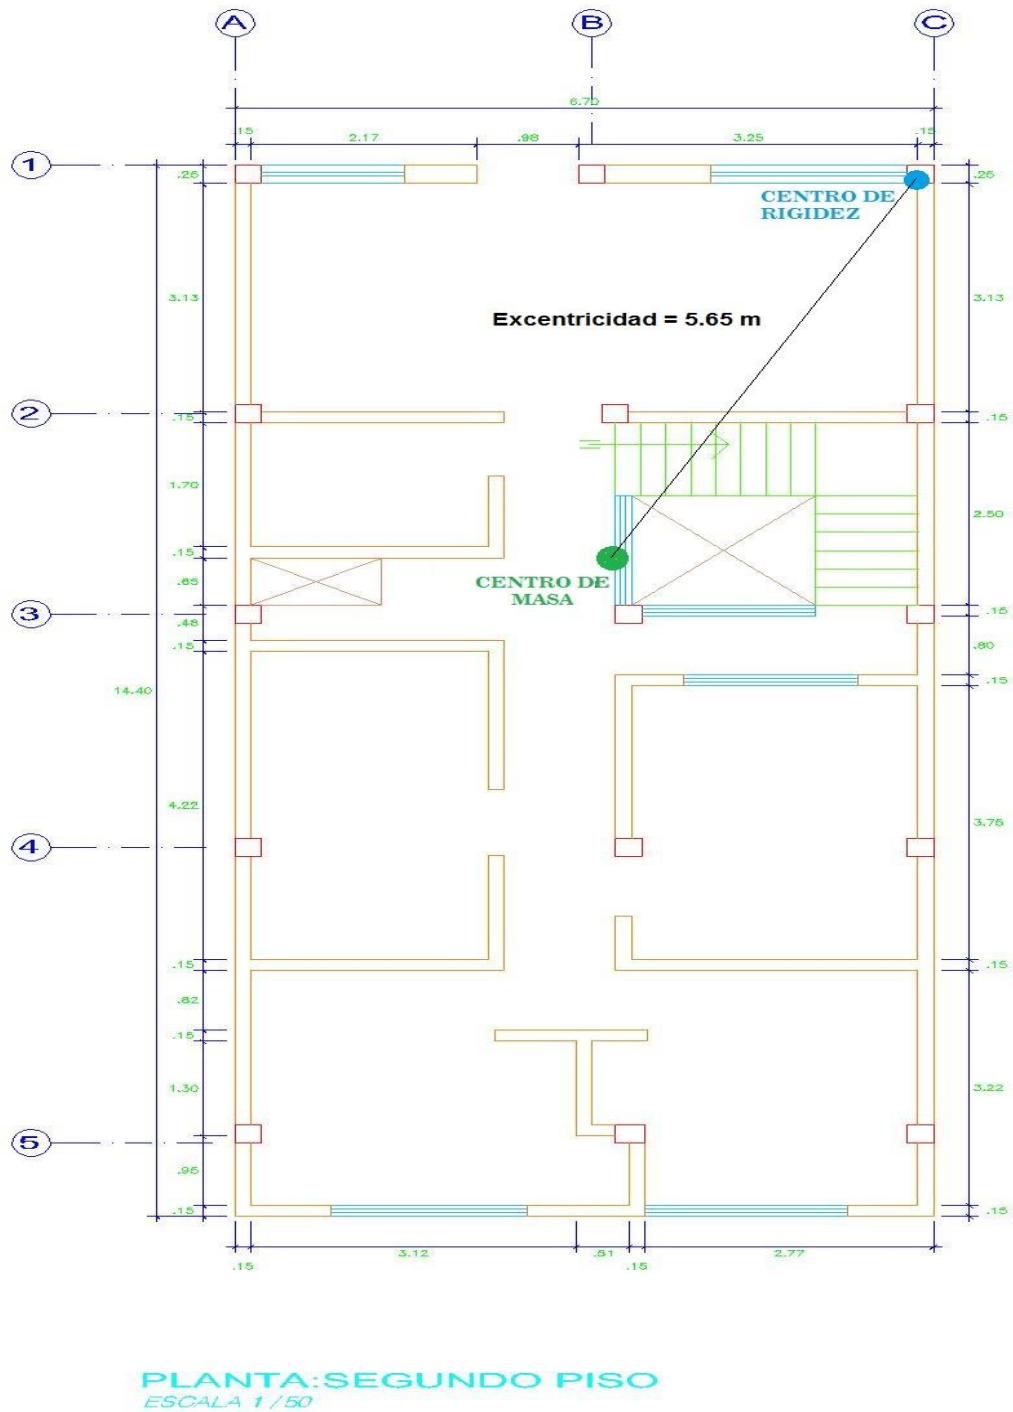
Ubicación del centro de masa y centro de rigidez en el plano de vista en planta del segundo piso- Lote 64 (Fuente: Elaboración propia)
